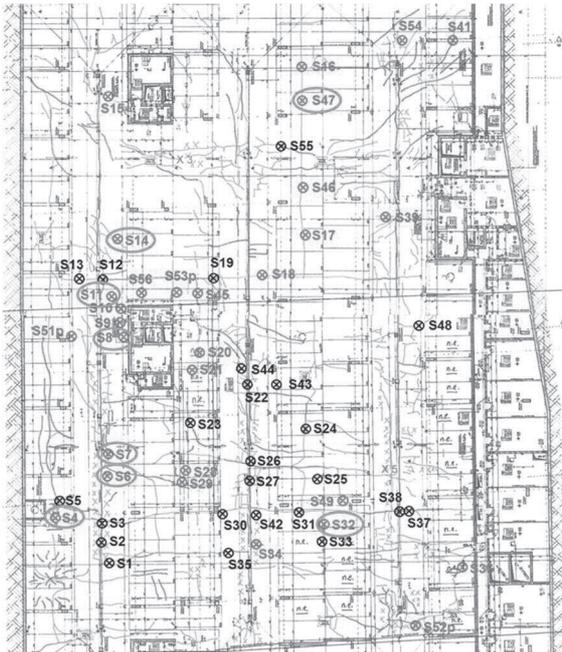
Grundriss einer Tiefgarage, die aufgrund verschiedener Beanspruchungen in großem Umfang Risse (Biege- und Trennrisse) aufweist
